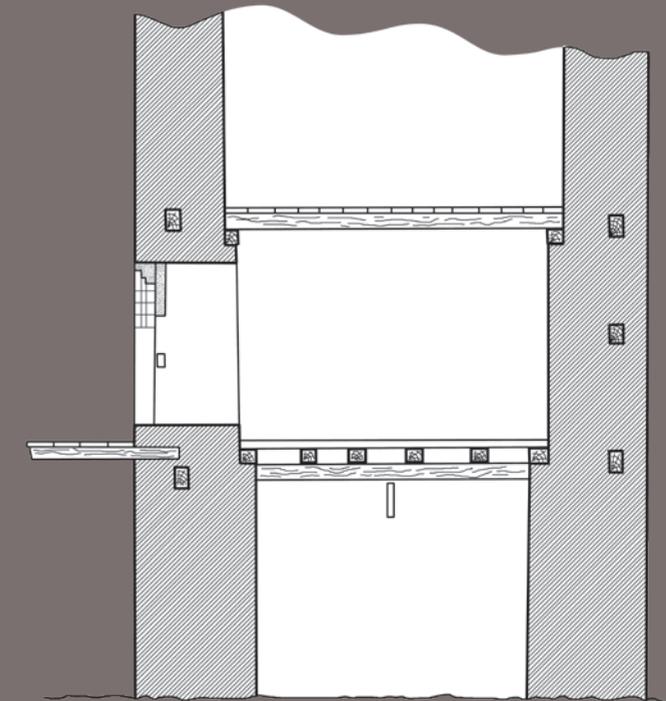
Wohnturm; Schnitt mit rekonstruierter Balkenlage, Hocheingang
